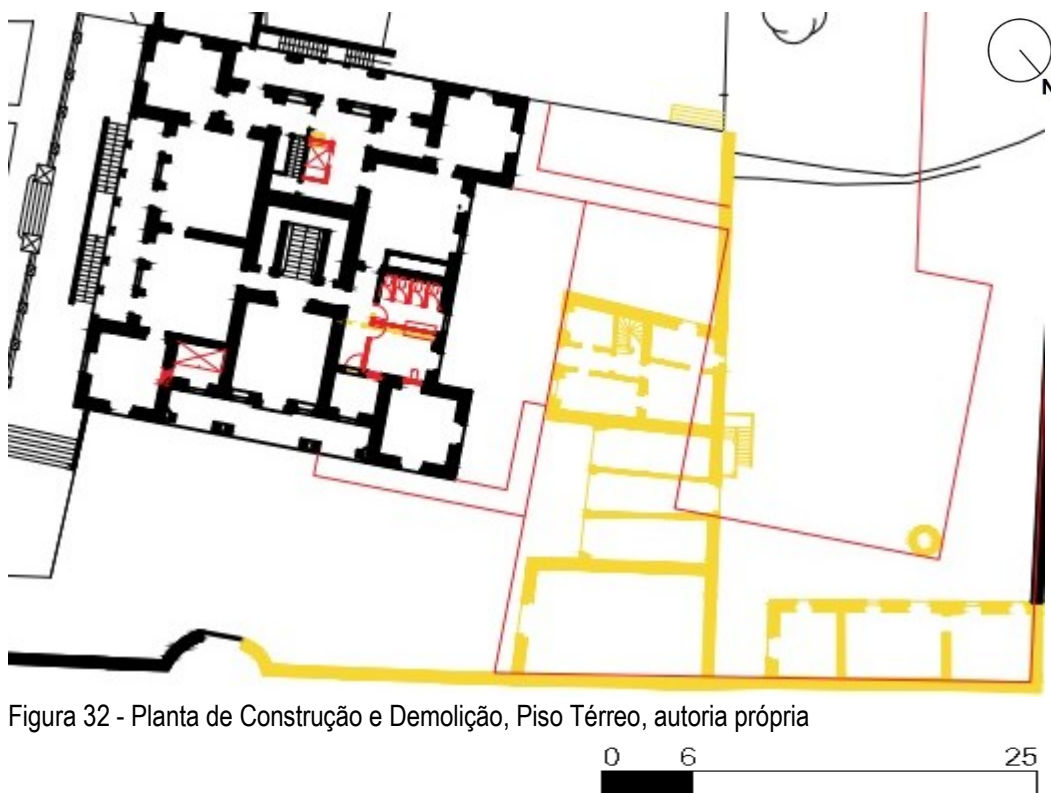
Planta de Construção e Demolição, Piso Térreo, autoria própria
